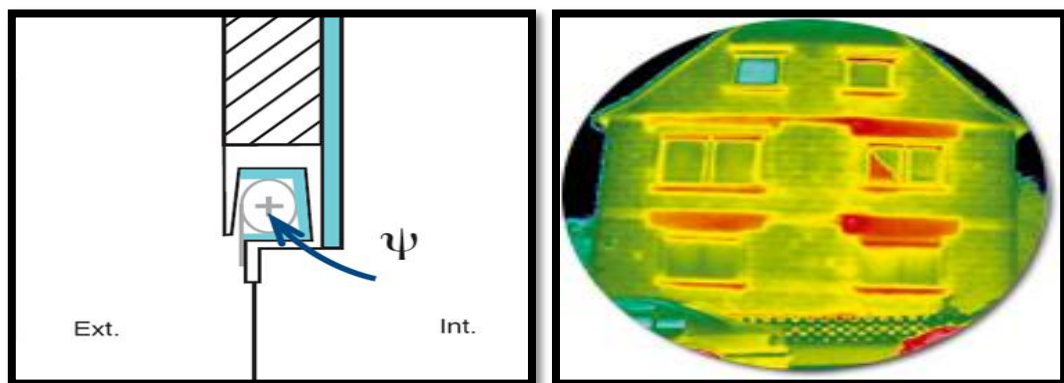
Ligação da Fachada com Caixa de Estore; RCCTE (2006); fonte: <http://www.mra.pt/ALAVA>
